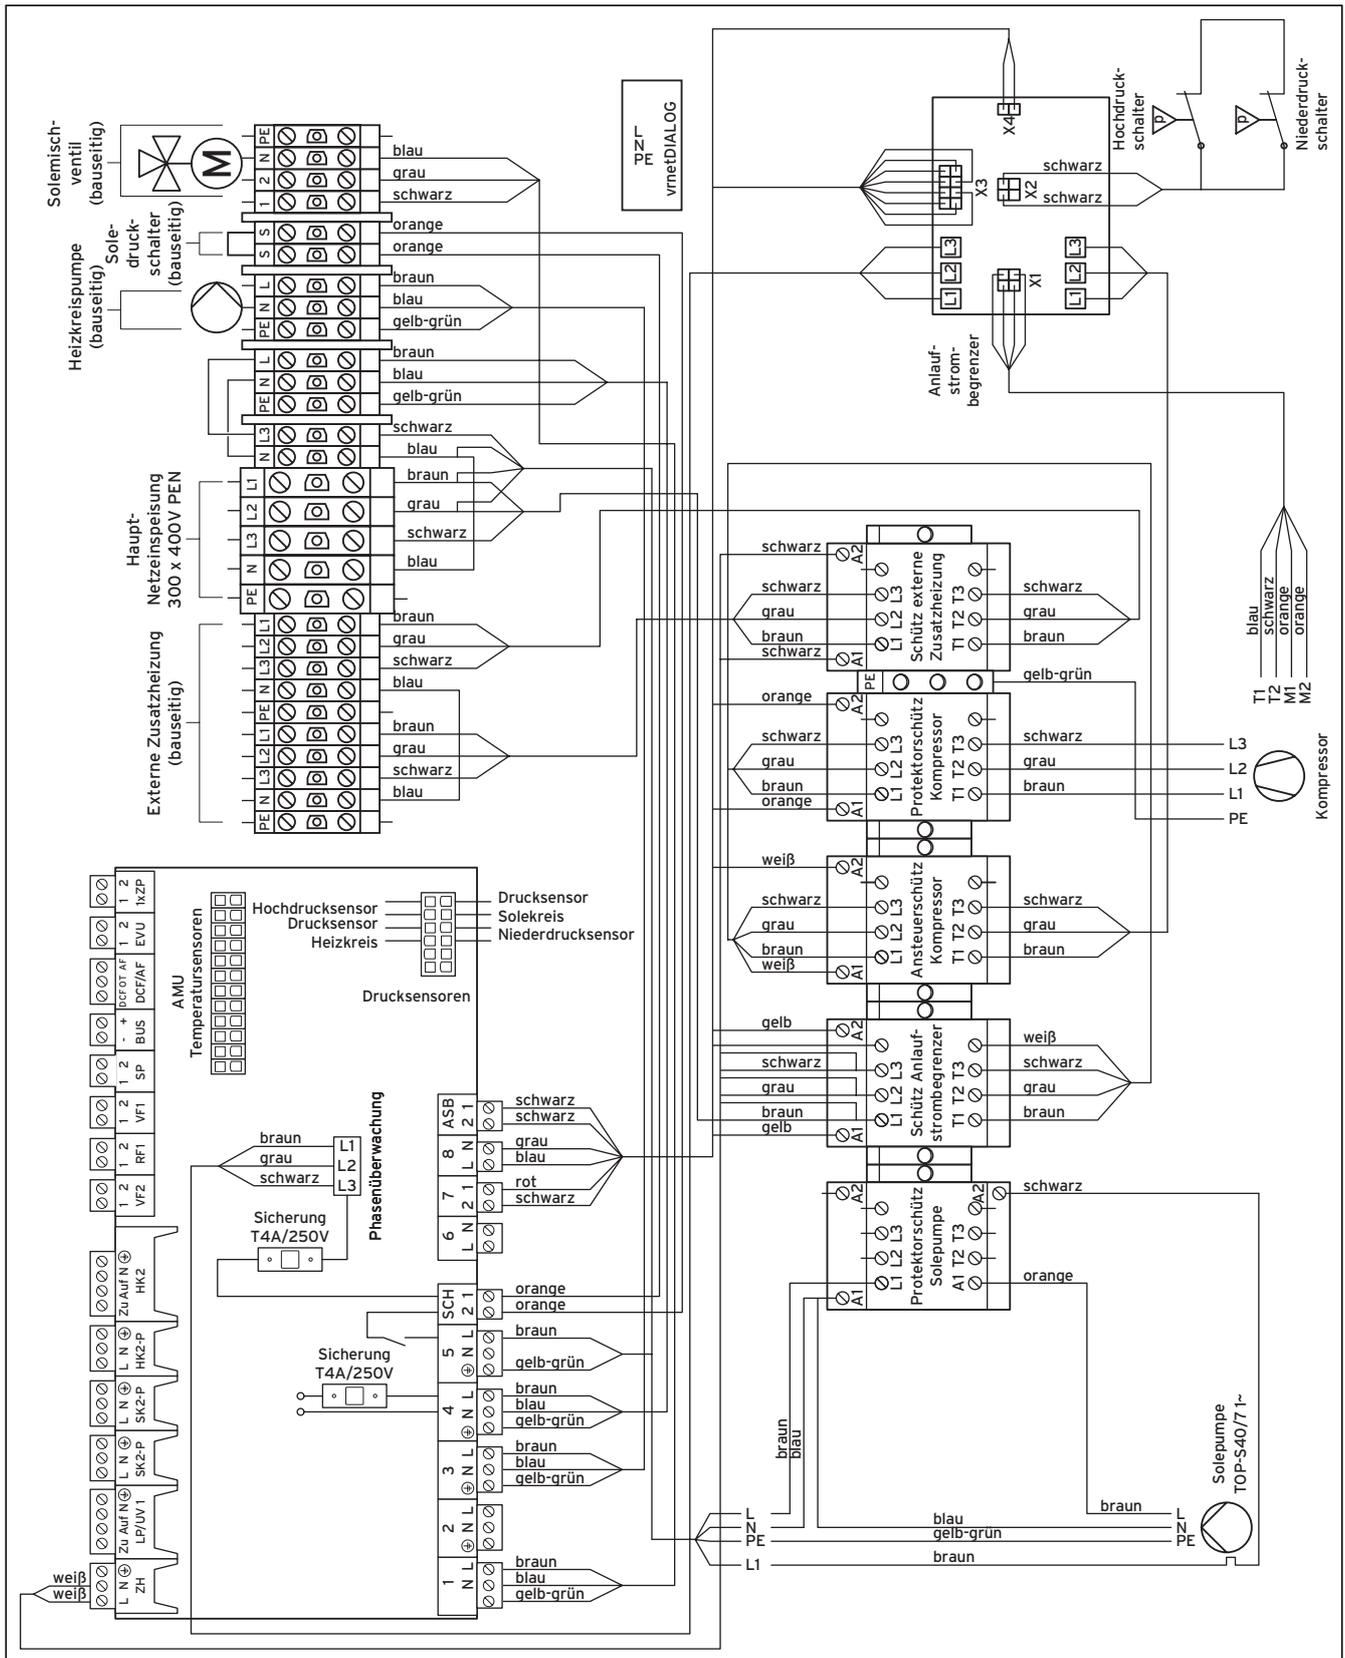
Anhang, Stromlaufplan VWS 220/2 - VWS 300/2
